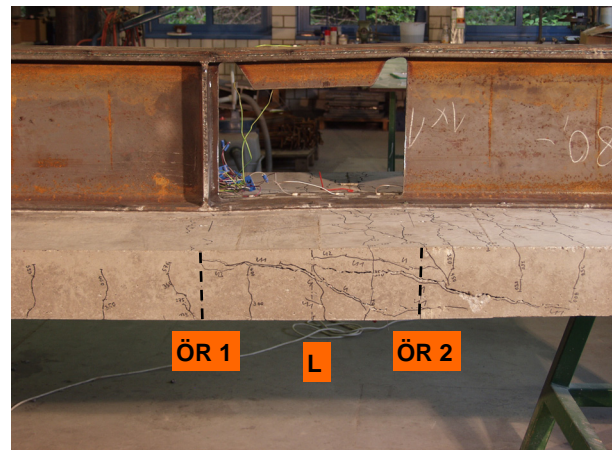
Rissbild auf der linken Betongurtseite
